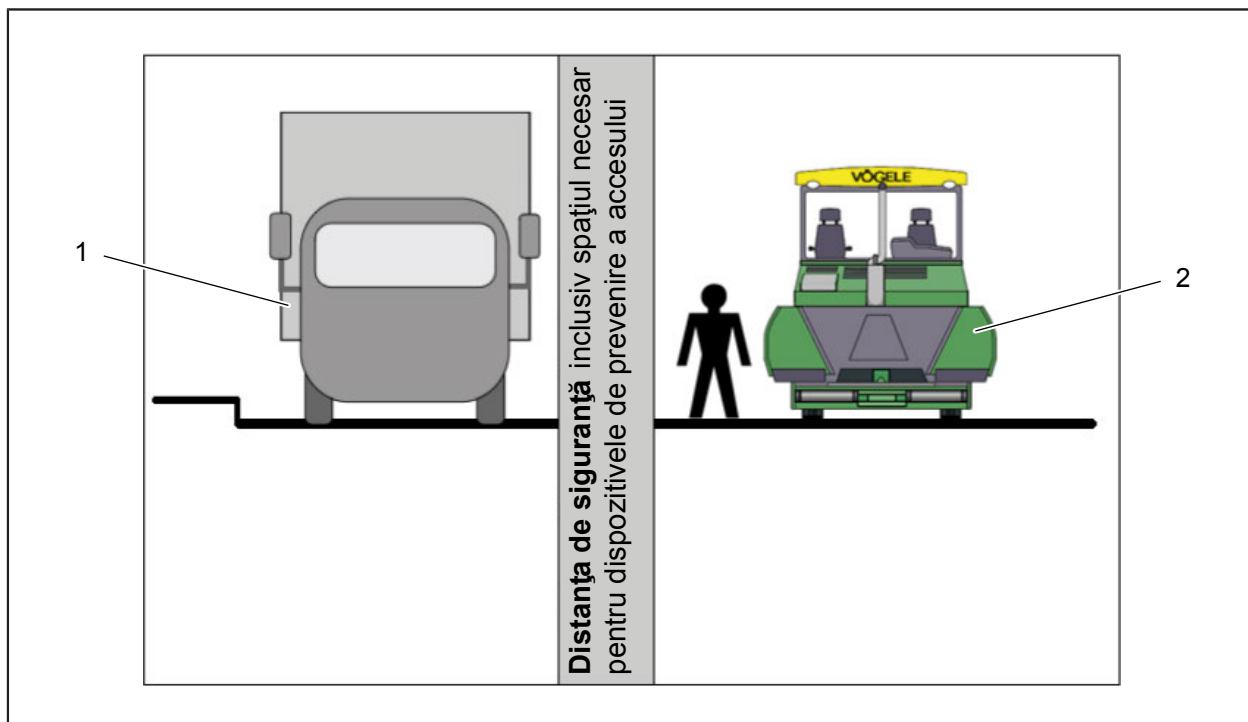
Distanța de siguranță dintre zona de lucru și zona de circulație publică
